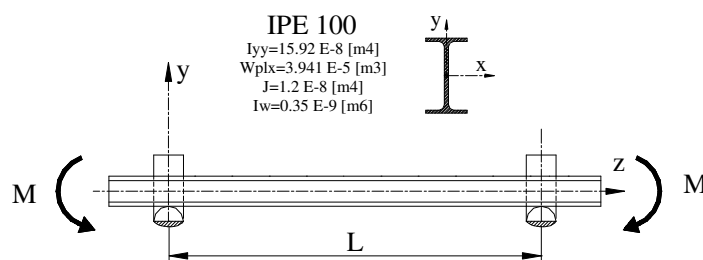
Viga simplesmente apoiada sujeita a flexão uniforme.
